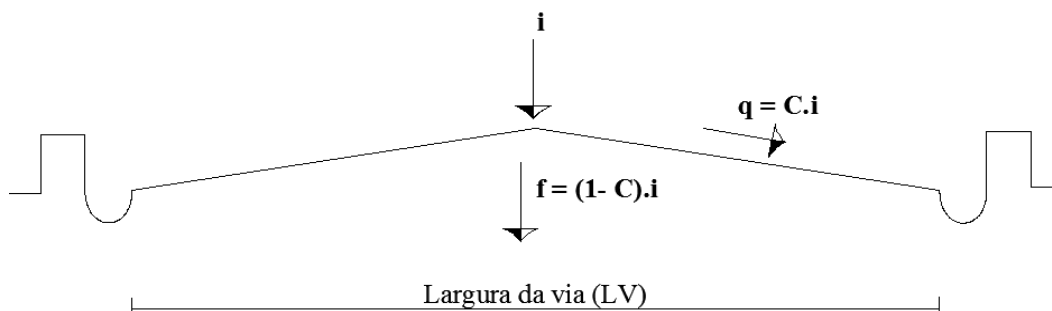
Modelo de escoamento superficial e infiltração do pavimento
